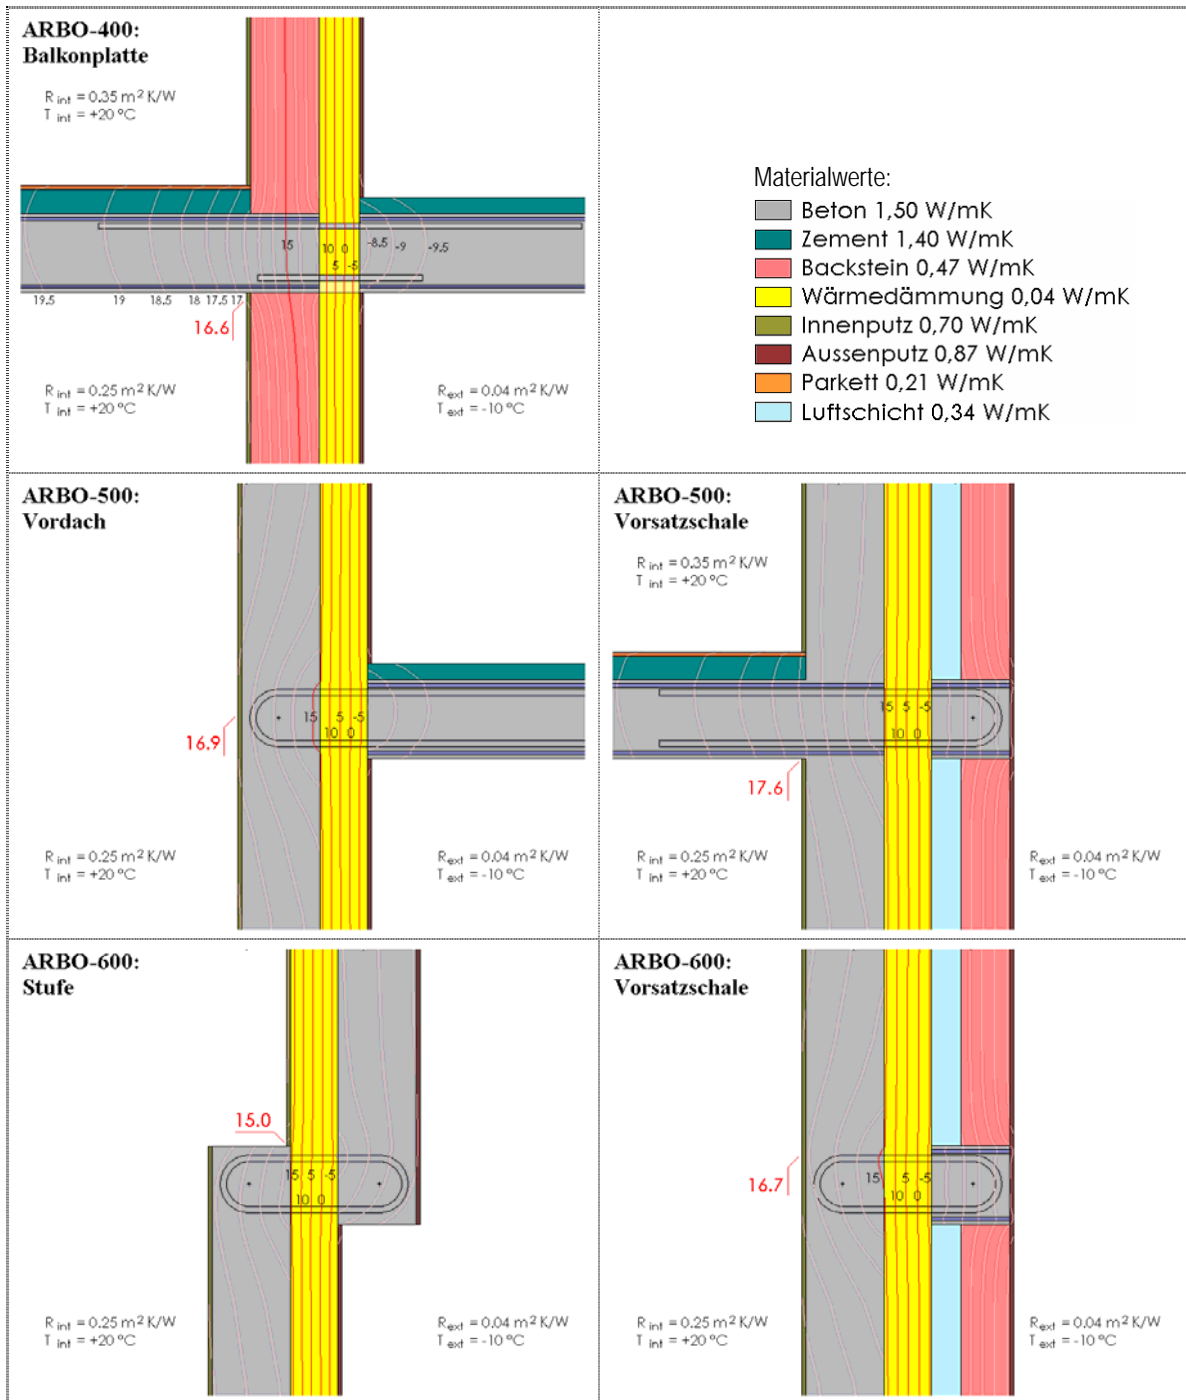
Drei Typen von Bewehrungselementen: Gerade Stäbe (oben), U-förmige (mitte) und geschlossene ovale (unten). Sie wirken als Wärmebrücken, da sie die Dämmschicht durchdringen, erlauben aber gerade eine Unterberechnung der Betonkonstruktion.
